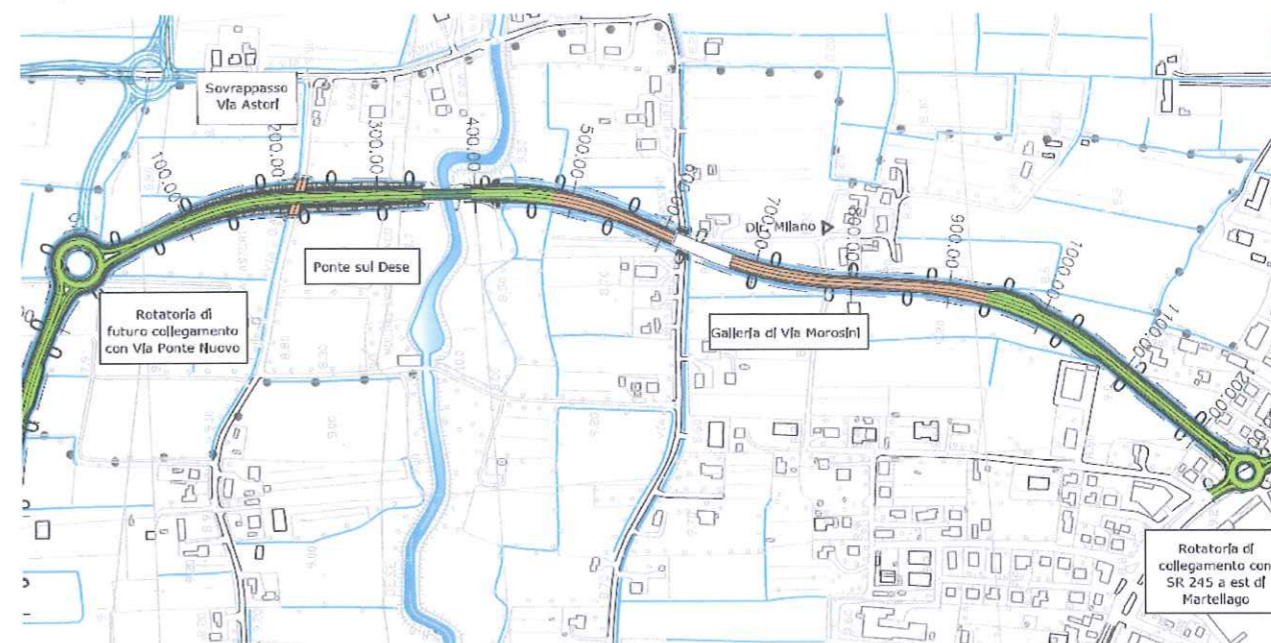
Viabilità di collegamento ad est – tratto dir. nord-sud
